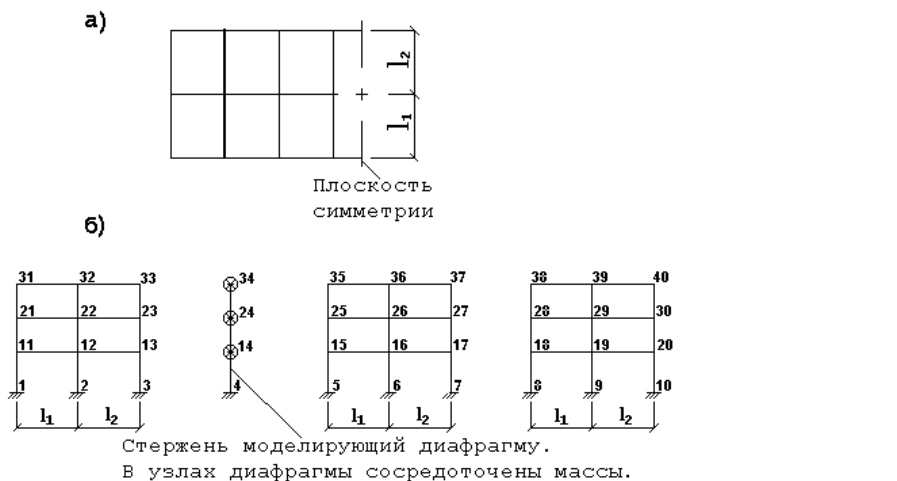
Замена пространственного каркаса здания плоской расчетной схемой
